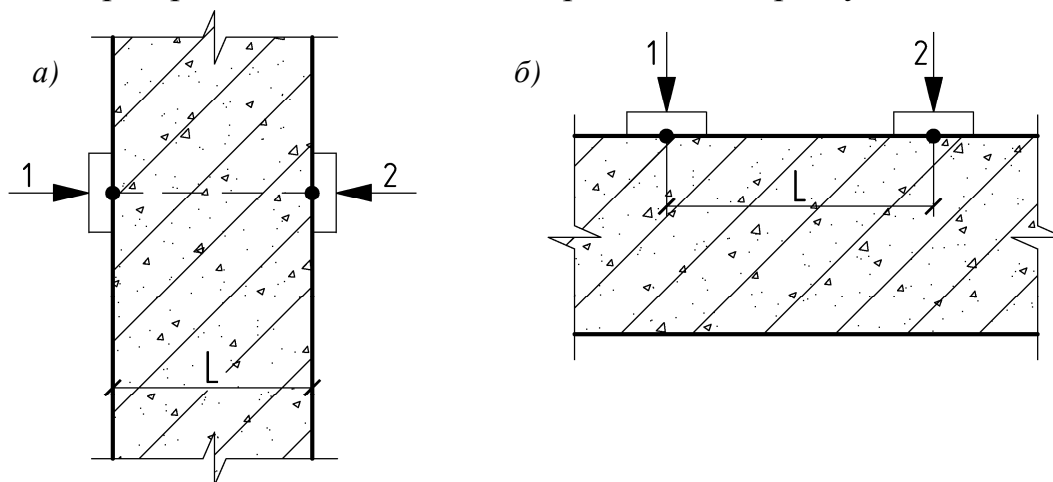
Способы сквозного (а) и поверхностного (б) прозвучивания изделий: 1, 2 – точки установки преобразователей; L – база прозвучивания
